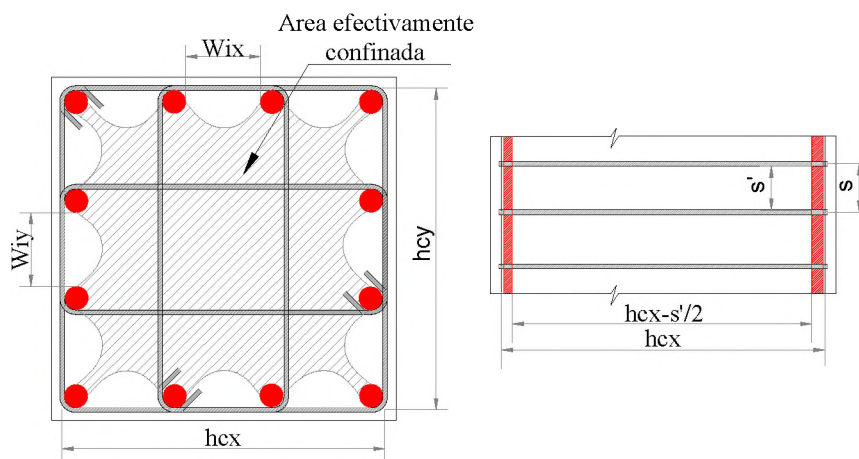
Confinamiento efectivo del concreto y el mecanismo de arco en columna de sección rectangular.
